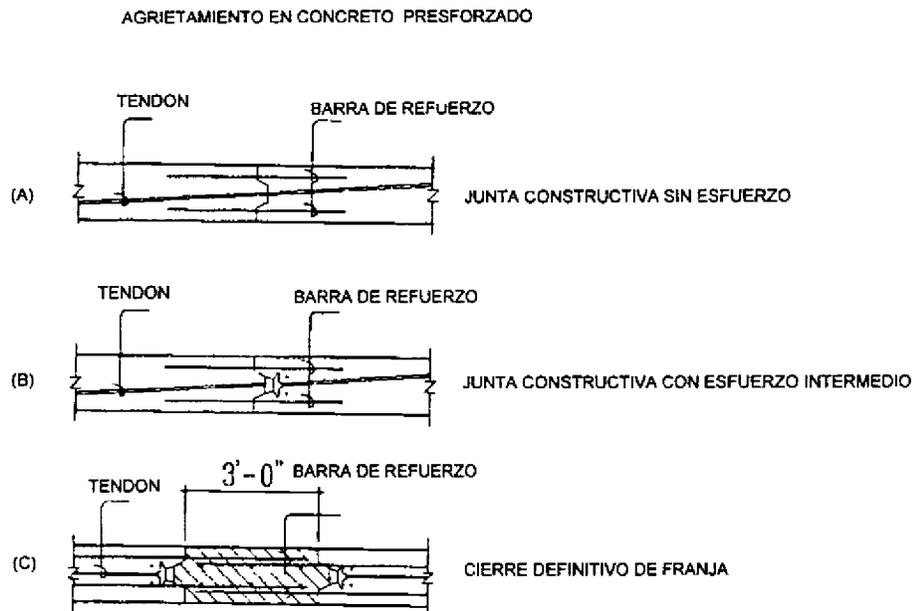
Franja de cerramiento (Aalami y Barth, 1989).
